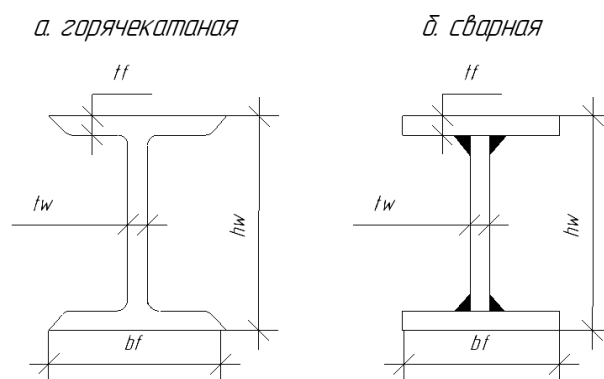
Конструктивный чертеж сечения сварной и горячекатаной балки
